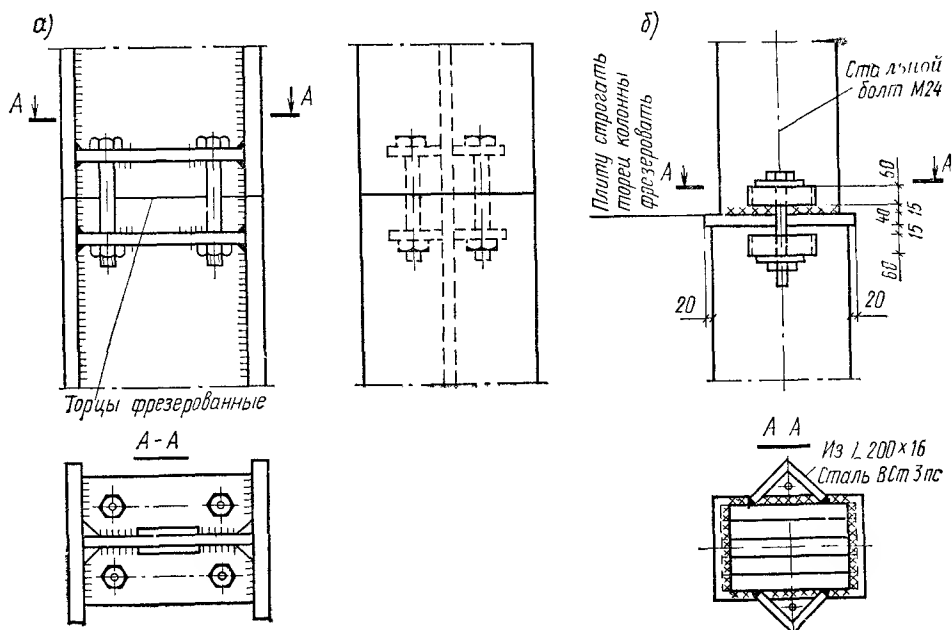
Стыки колонн с фрезеровкой торцов и стяжными болтами
